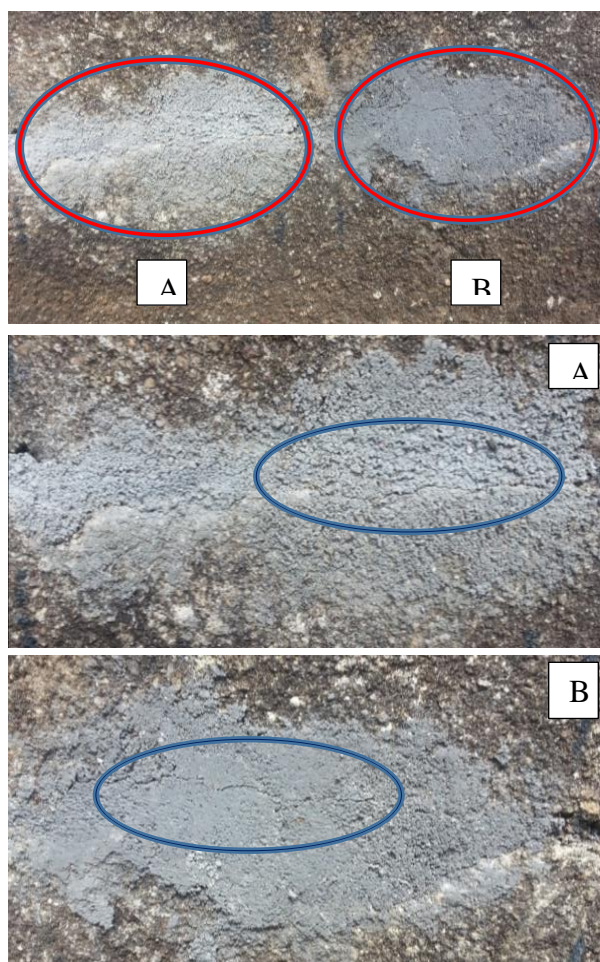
Microfissuras nas argamassas sentido horizontal, 7º dia, A – Argamassa testemunha, B – Argamassa adicionada de CCAV.
